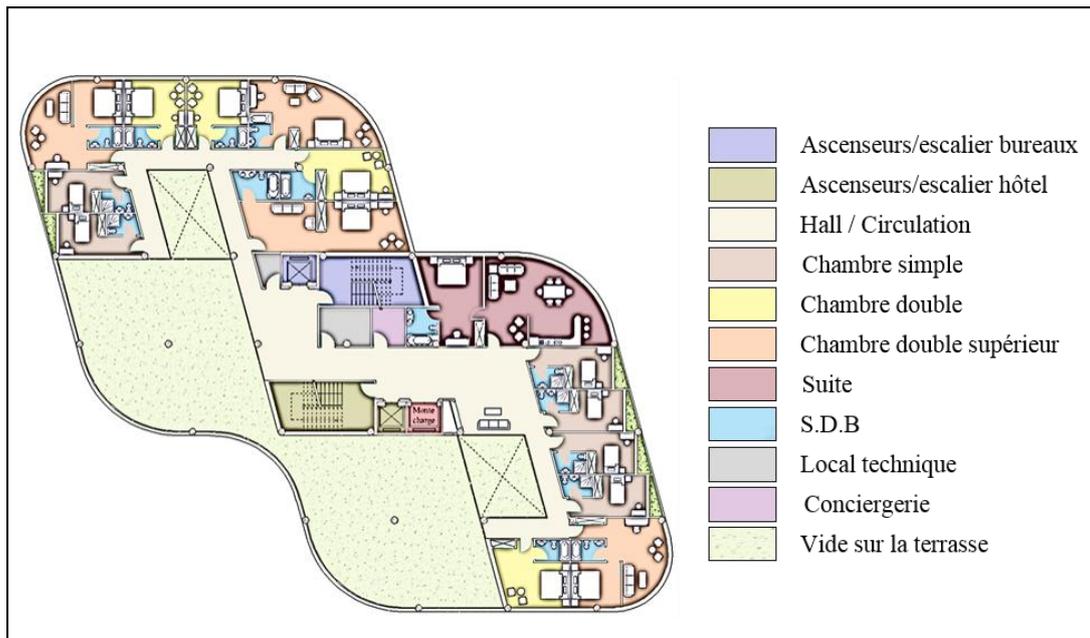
Plan 8^{ème} étage (source : auteurs)
